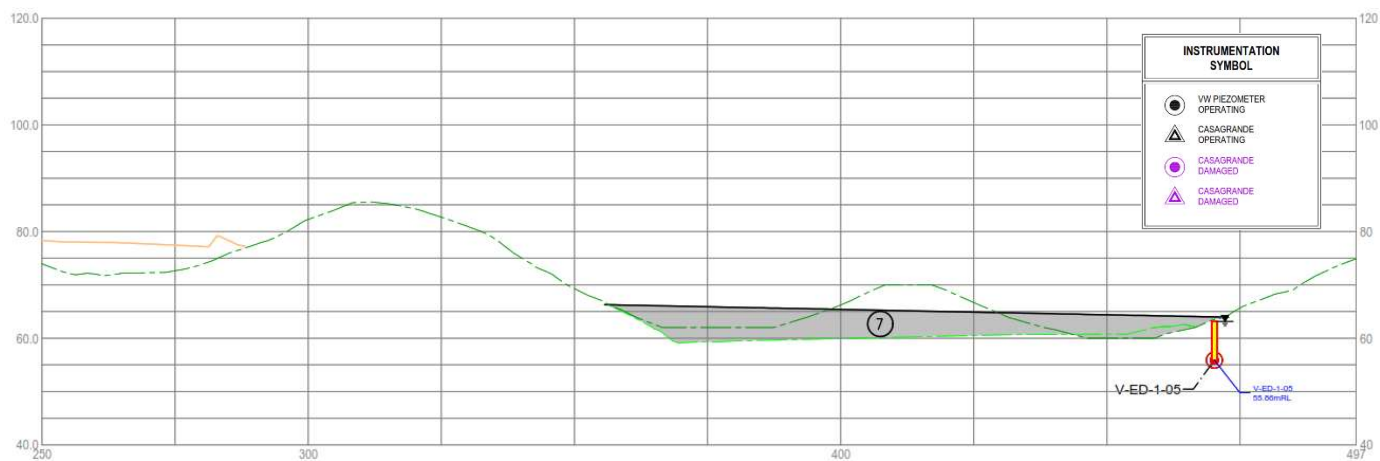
6: Vista de sección PE WRP1 "P-D"
